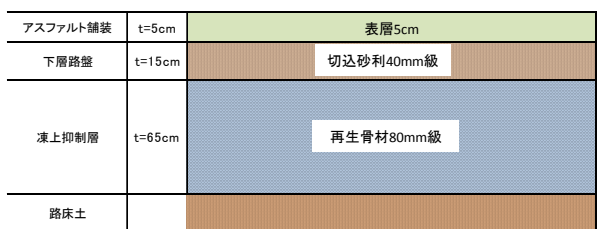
試験施工箇所 (芦別市) 施工時期 H24.9
